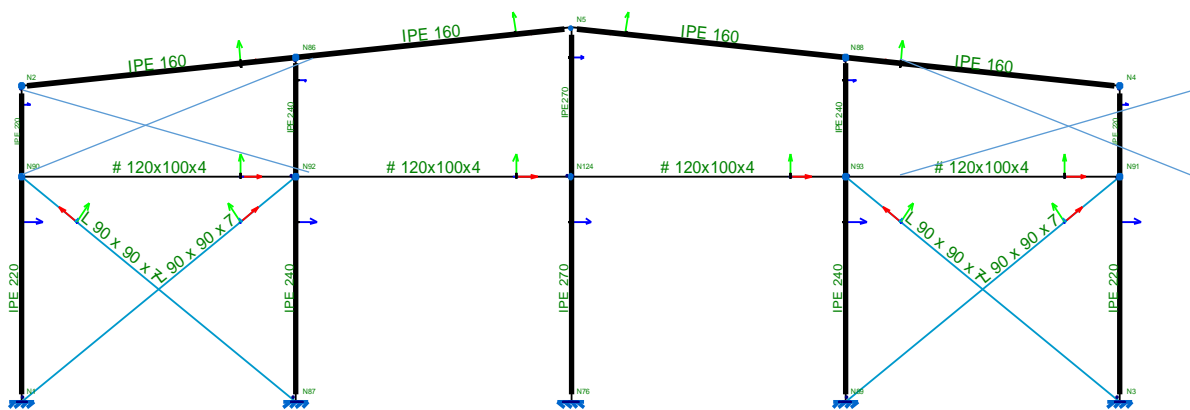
Pórtico de fachada frontal con indicación de sus perfiles
